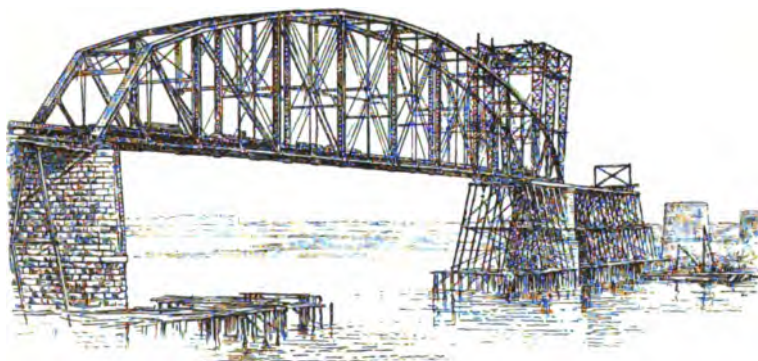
Pont des Marchands. — Montage (d'après l'Engineering News)
